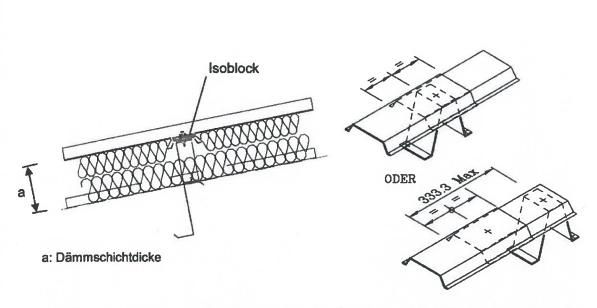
DOPPELSCHALIGES DACH MIT AUFSTÄNDERUNGSKONSTRUKTION (Omega System)
